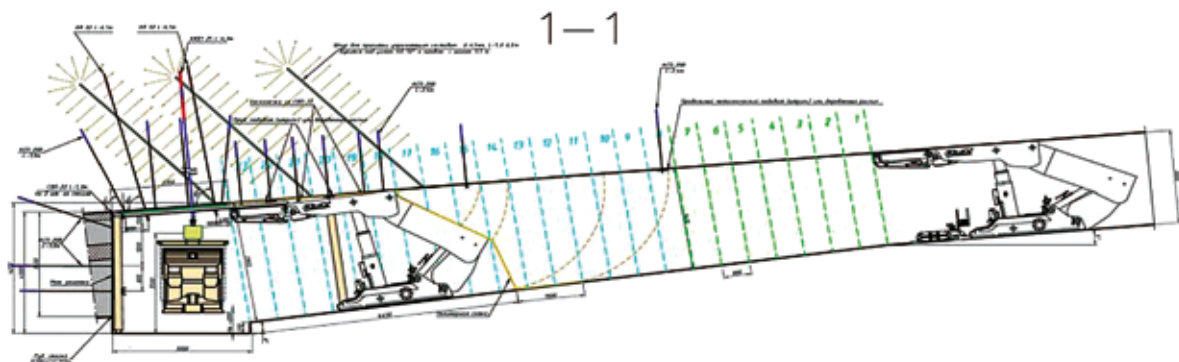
Схема формирования и крепления демонтажной камеры 1-1-5-7:
